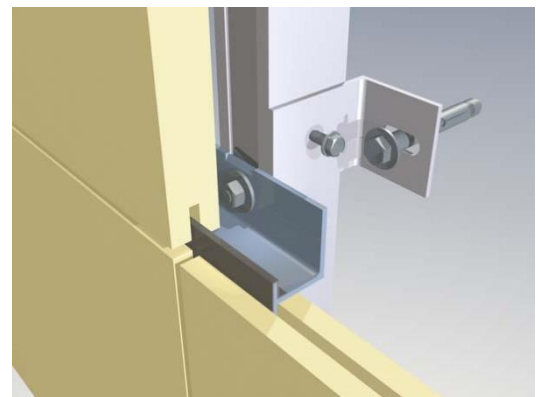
Sistema de montaje mecánico de piedras laminadas, estas se montan sobre piezas de acero en perforaciones previamente hechas al laminado. Foto www.stonesoge.com (Reproducción hecha con fines didácticos)
